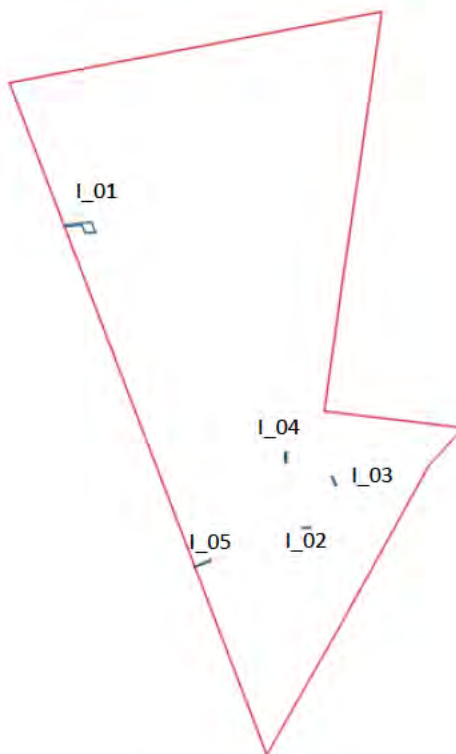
Ubicación de las 5 secciones de áreas para infraestructura.
